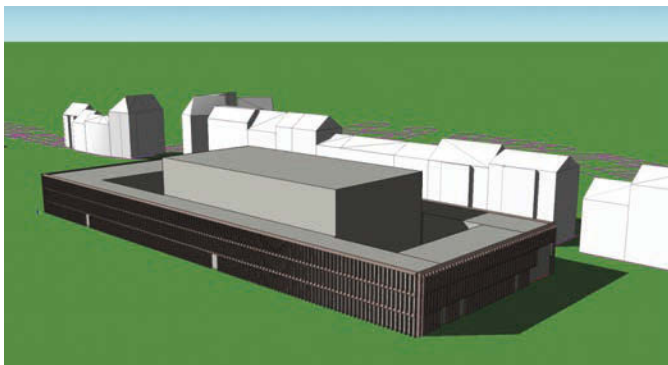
Simulationsmodell – Gebäudekörper und Nachbarbebauung
